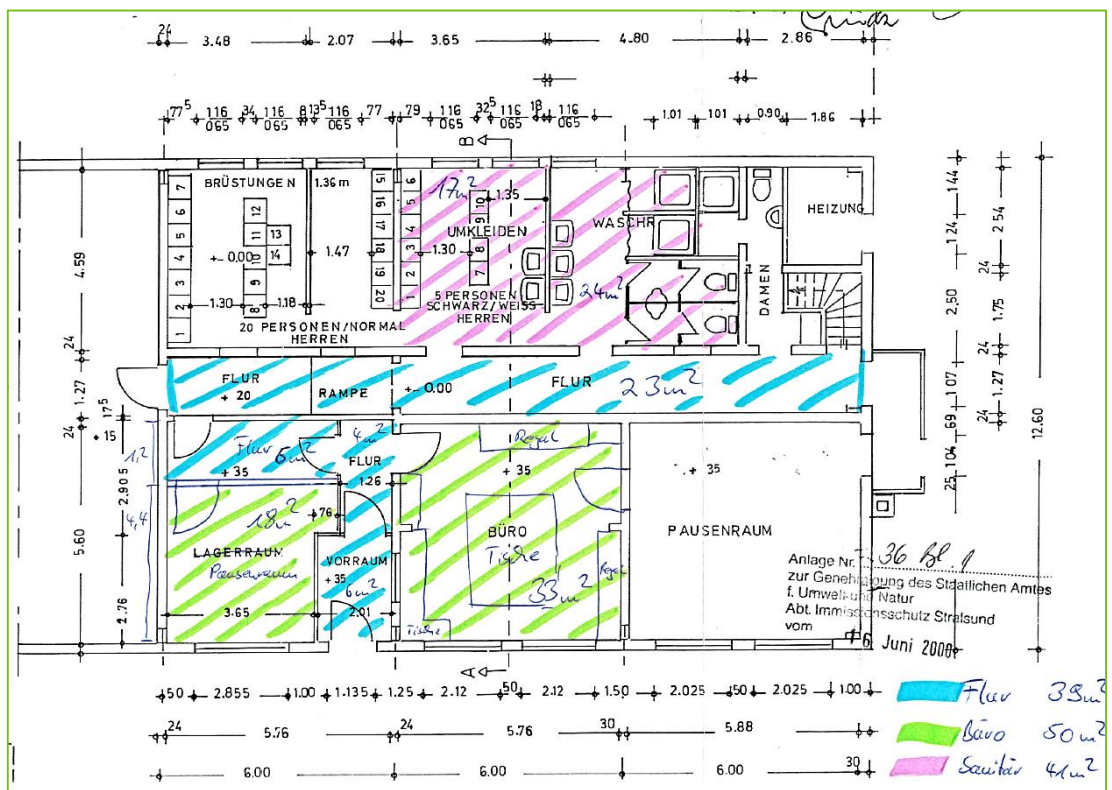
Auszug Grundriss Sozialgebäude (BE 01)
